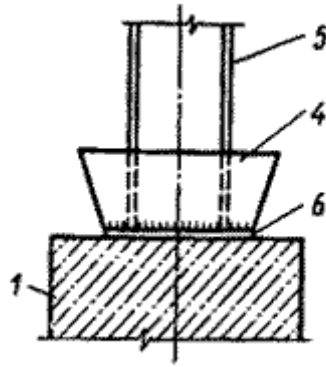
Схема спирання металевих колон на фундаменти зведений до проектної відмітки
